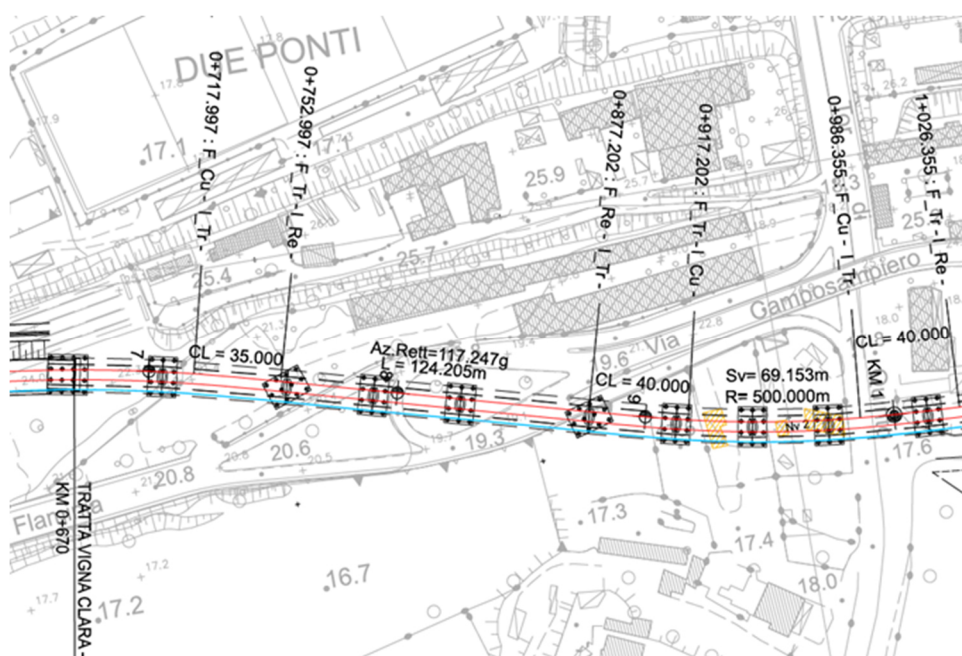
Stralcio planimetrico: intersezione con via Flaminia Vecchia
